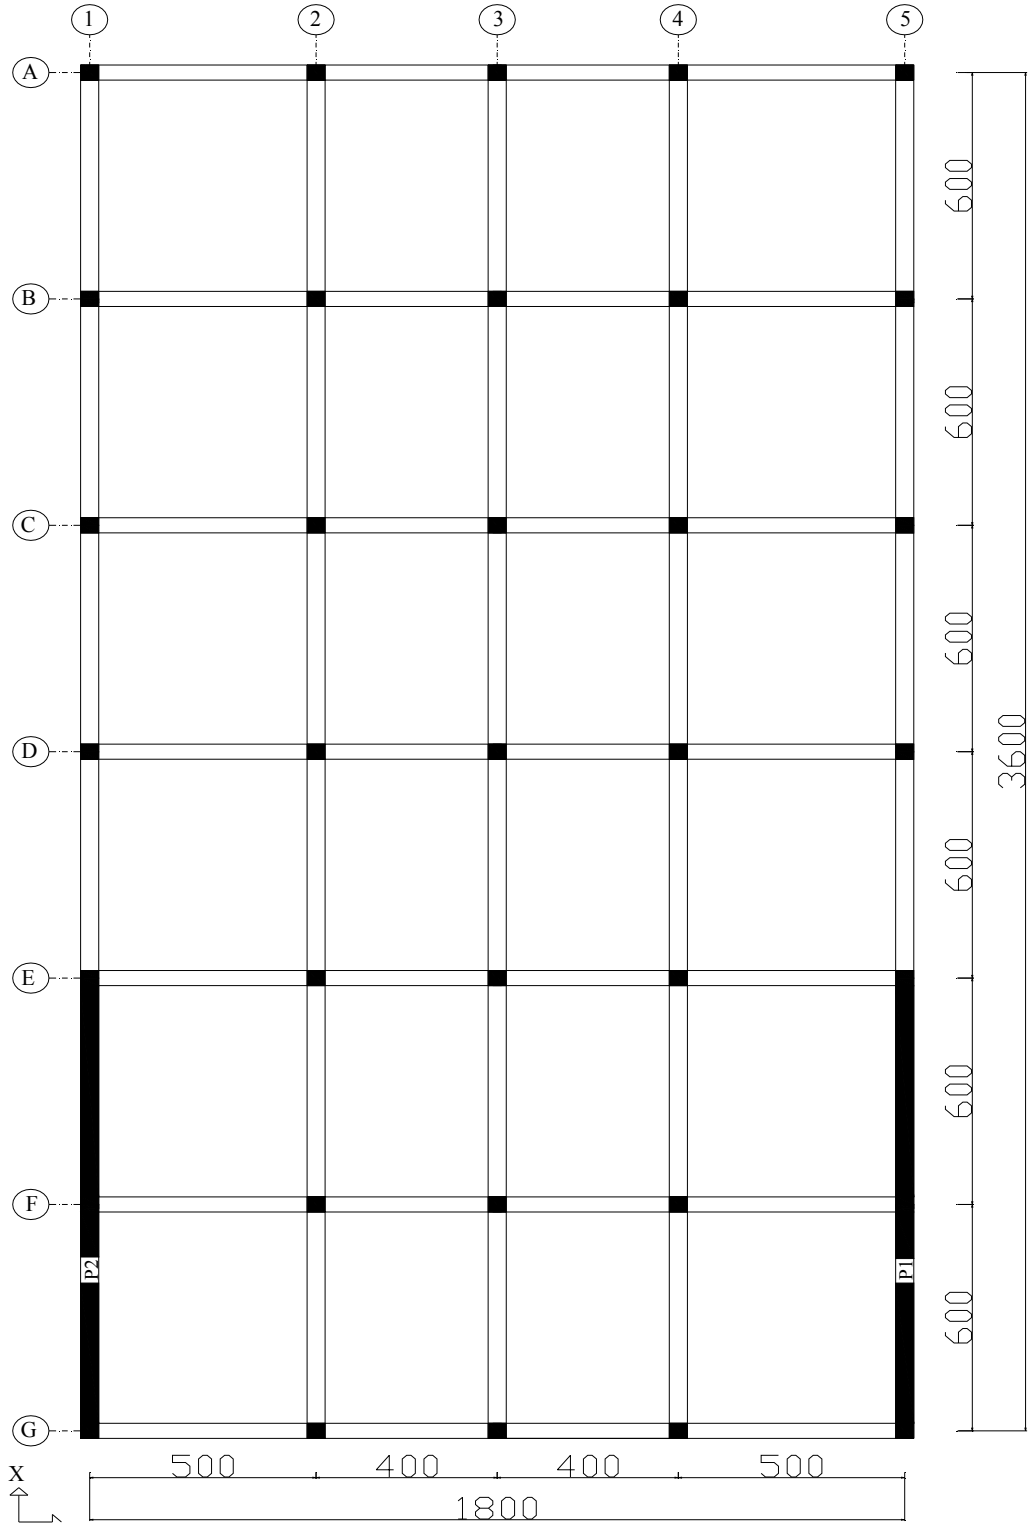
Örnek 5.8'in kat kalıp planı
